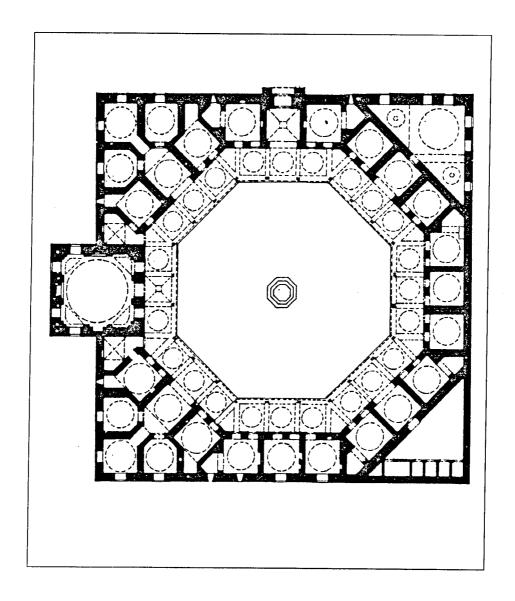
مسقط أفقي لمدرسة غازي خسرو بك في سراييفو (عن : إيفردى) .
